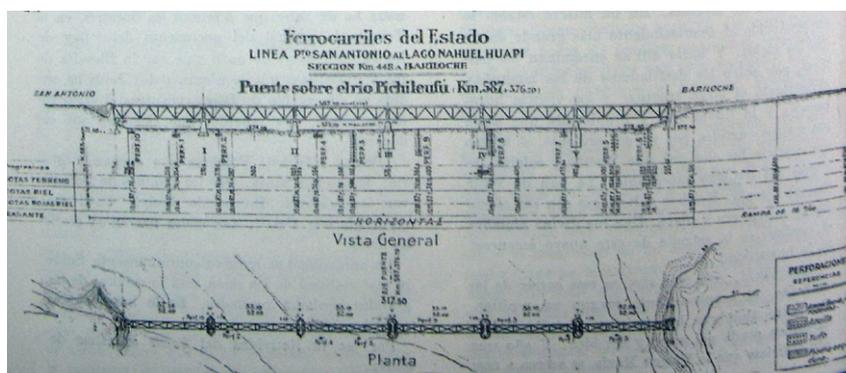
Puente sobre el río Pichileufú, vista general y planta. El proyecto fija seis tramos metálicos de vía superior, de 52 m de luz teórica, de 7,50 m de altura y 5 m de ancho. Con una longitud total de puente entre ejes de apoyos sobre estribos de 317,50 m. La subestructura del puente estaría constituida por dos estribos en los extremos y cinco pilares –todos en hormigón armado– en la parte intermedia. Respondiendo a las diferencias geológicas del sub-suelo, se proyectan dos tipos de fundaciones para los pilares y los estribos se idean también en forma distinta. Será proseguida la línea férrea de San Antonio a Bariloche (1930, dic.). *Riel y Fomento*, 104, 10.
